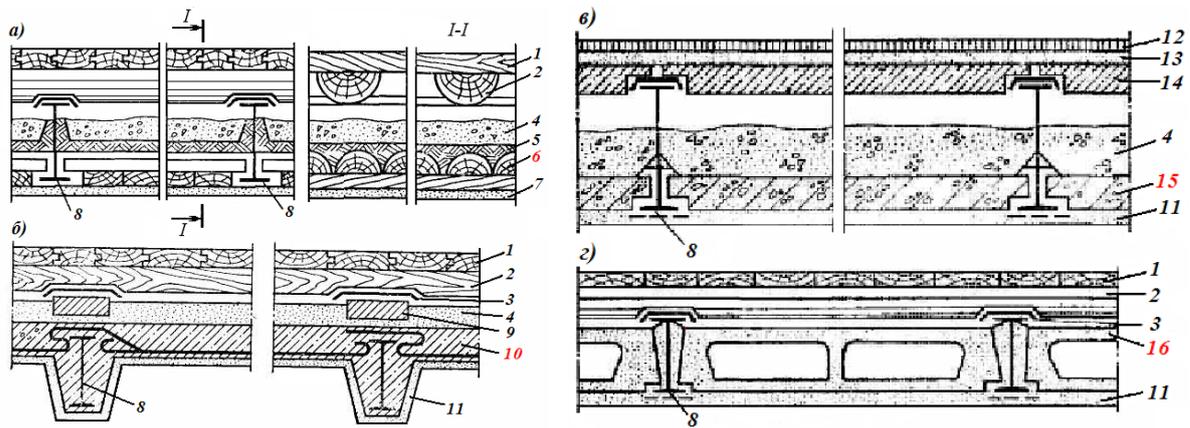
Междуетажные перекрытия по стальным балкам: а – перекрытие по стальным балкам с деревянным заполнением; б – то же, с монолитной железобетонной плитой; в, г – то же, с заполнением из сборных плит или блоков
